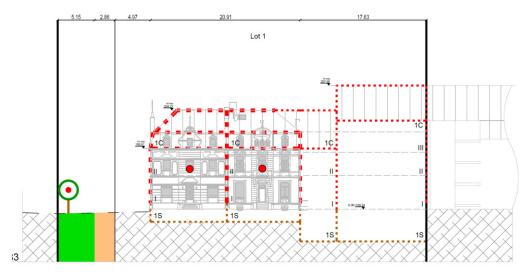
Coupe schématique des constructions de la « route de Remich » (Source : BEST)
